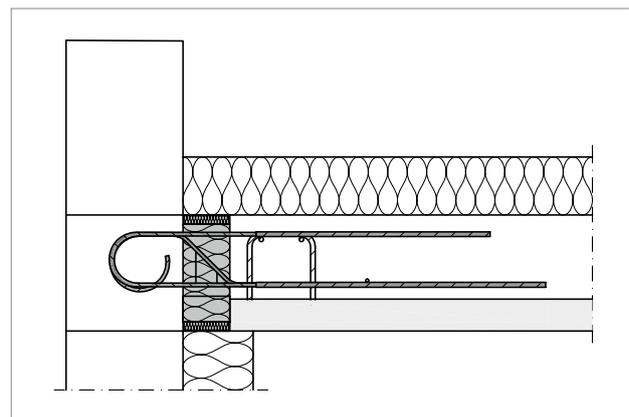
Schöck Rutherma® T type DF : liaison pour l'acrotère et dalle en prédalle
